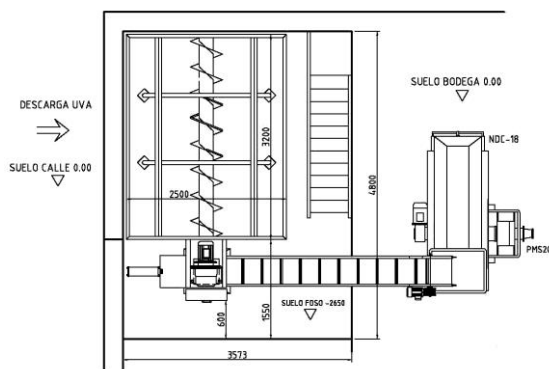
Plano de planta de tolva y estrujadora alimentada con cinta transportadora.
